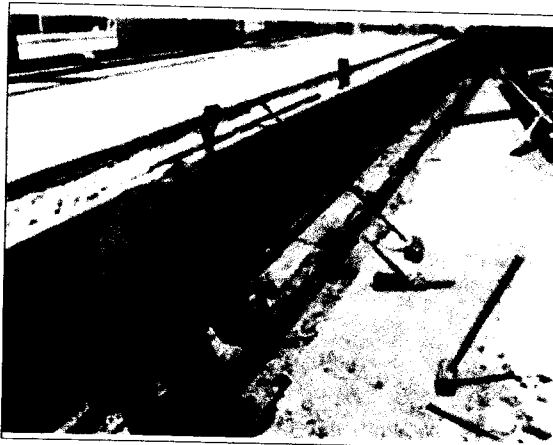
PICADO PARA COLOCACION DE ANGULOS
